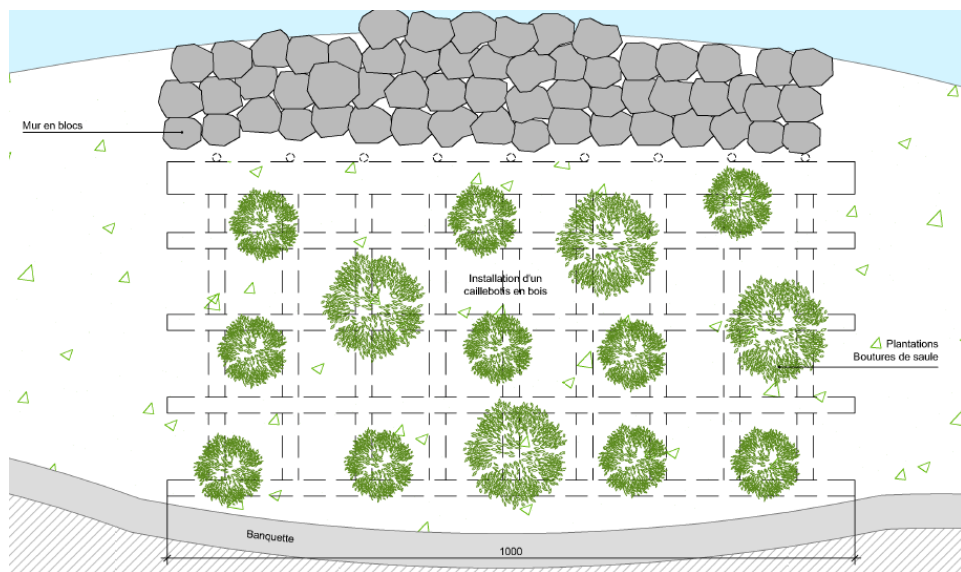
Proposition d'assainissement : mur en blocs et grille en bois (plan de situation)
